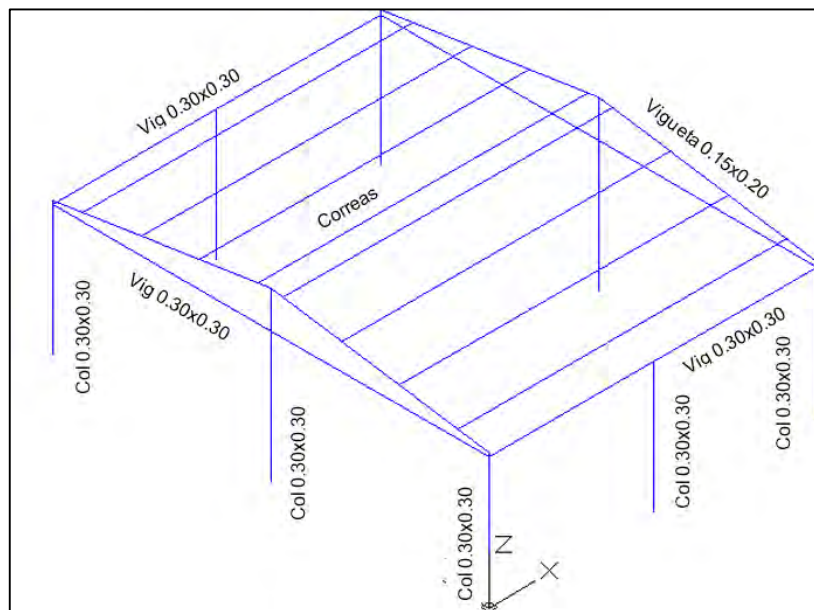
Configuración de elementos estructurales.
